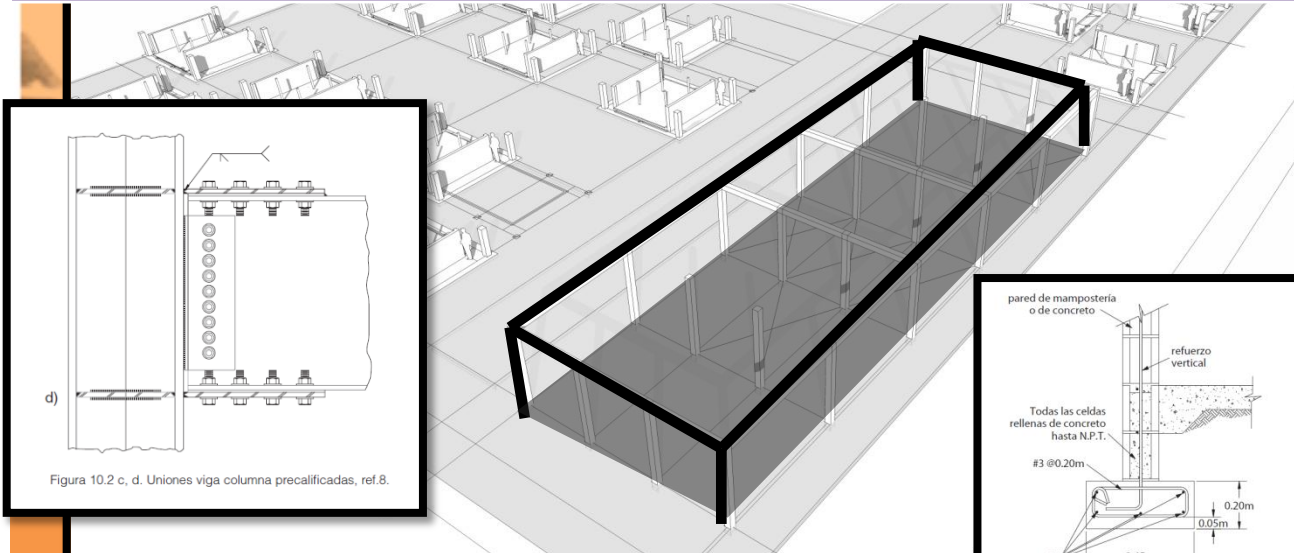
c, d. Uniones viga columna precalificadas, ref.8.
